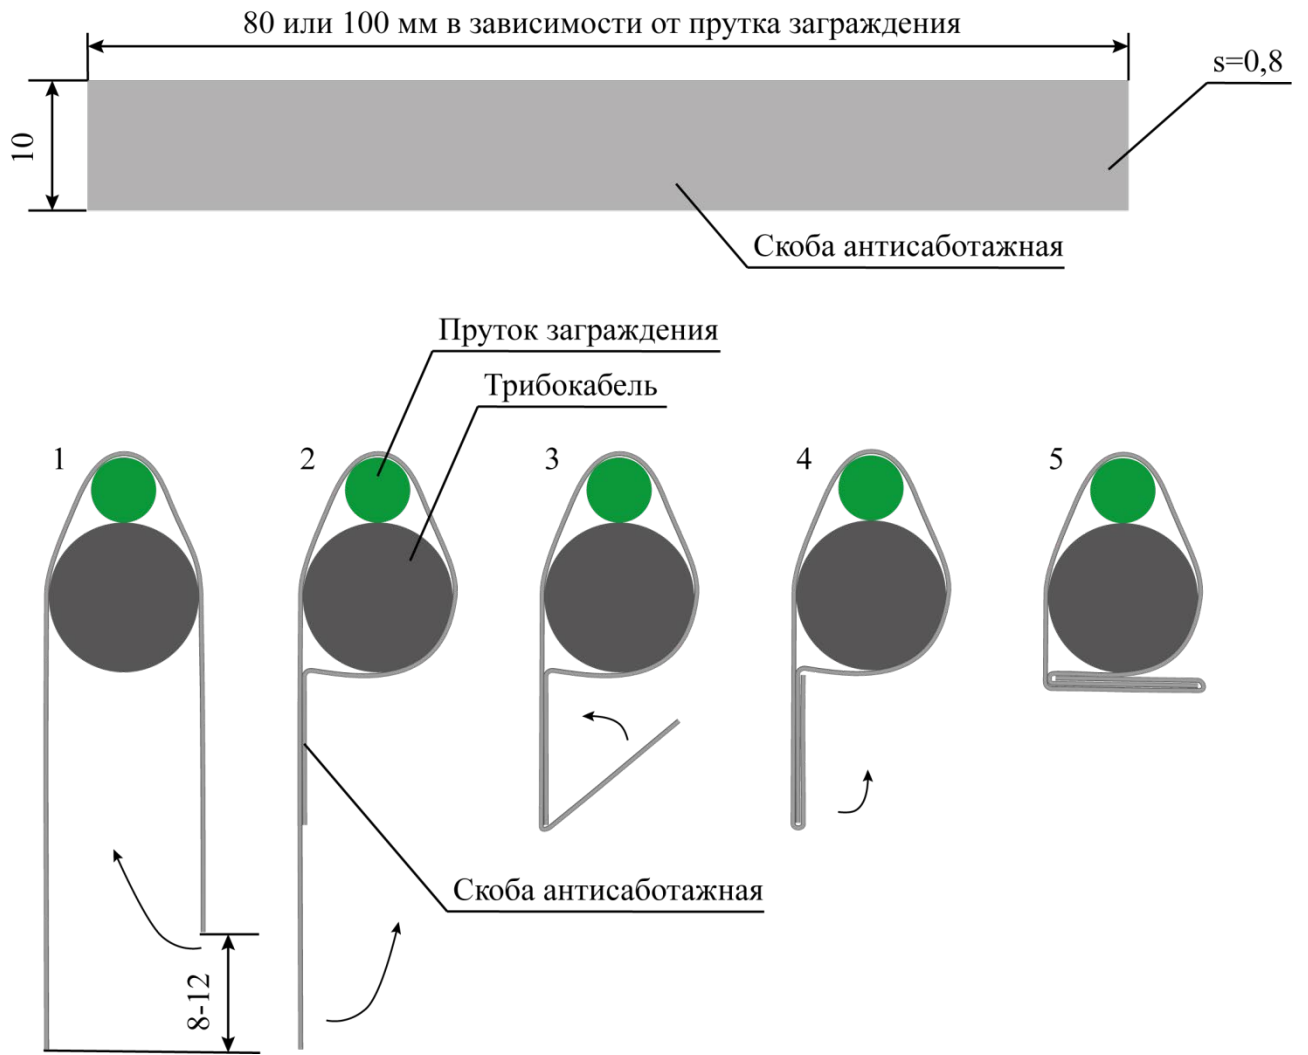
Порядок монтажа скобы антисаботажной на заграждении
